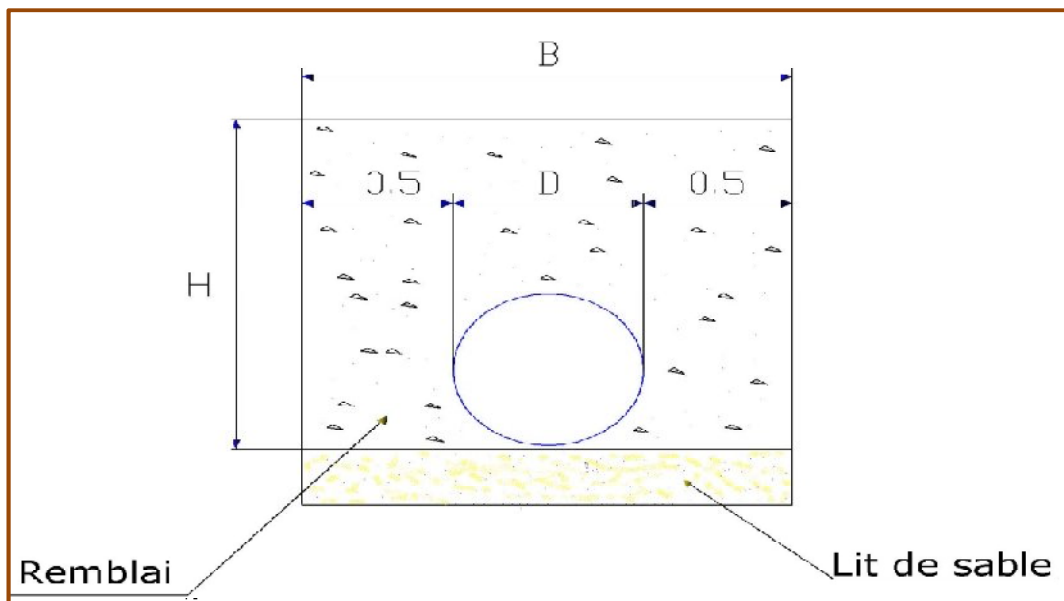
Coupes en travers de la tranchée de la conduite.
